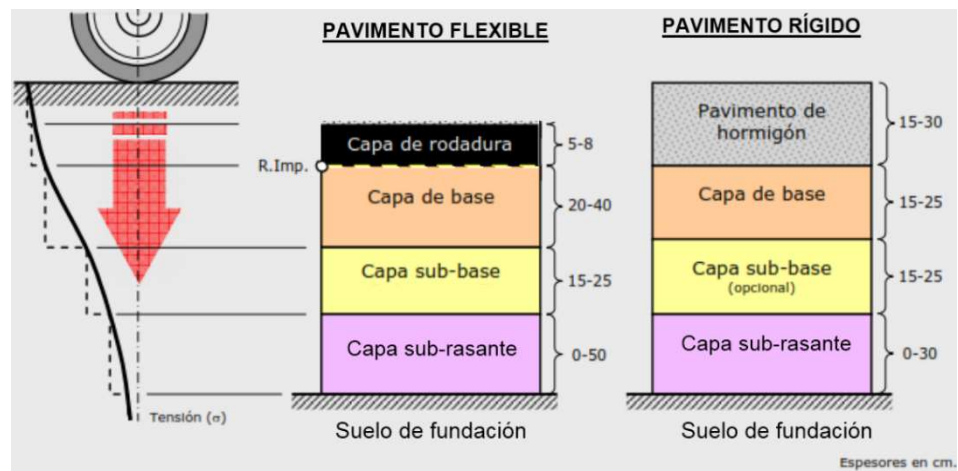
Diferencias estructurales de un pavimento rígido y flexible.
